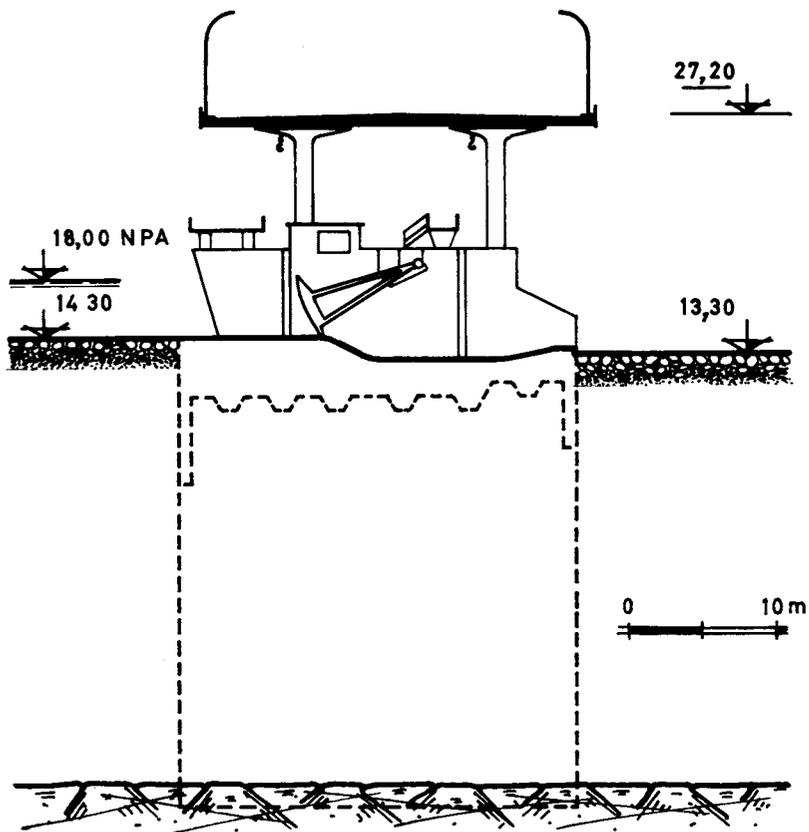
Corte do açude-ponte intersectando a soleira descarregadora
